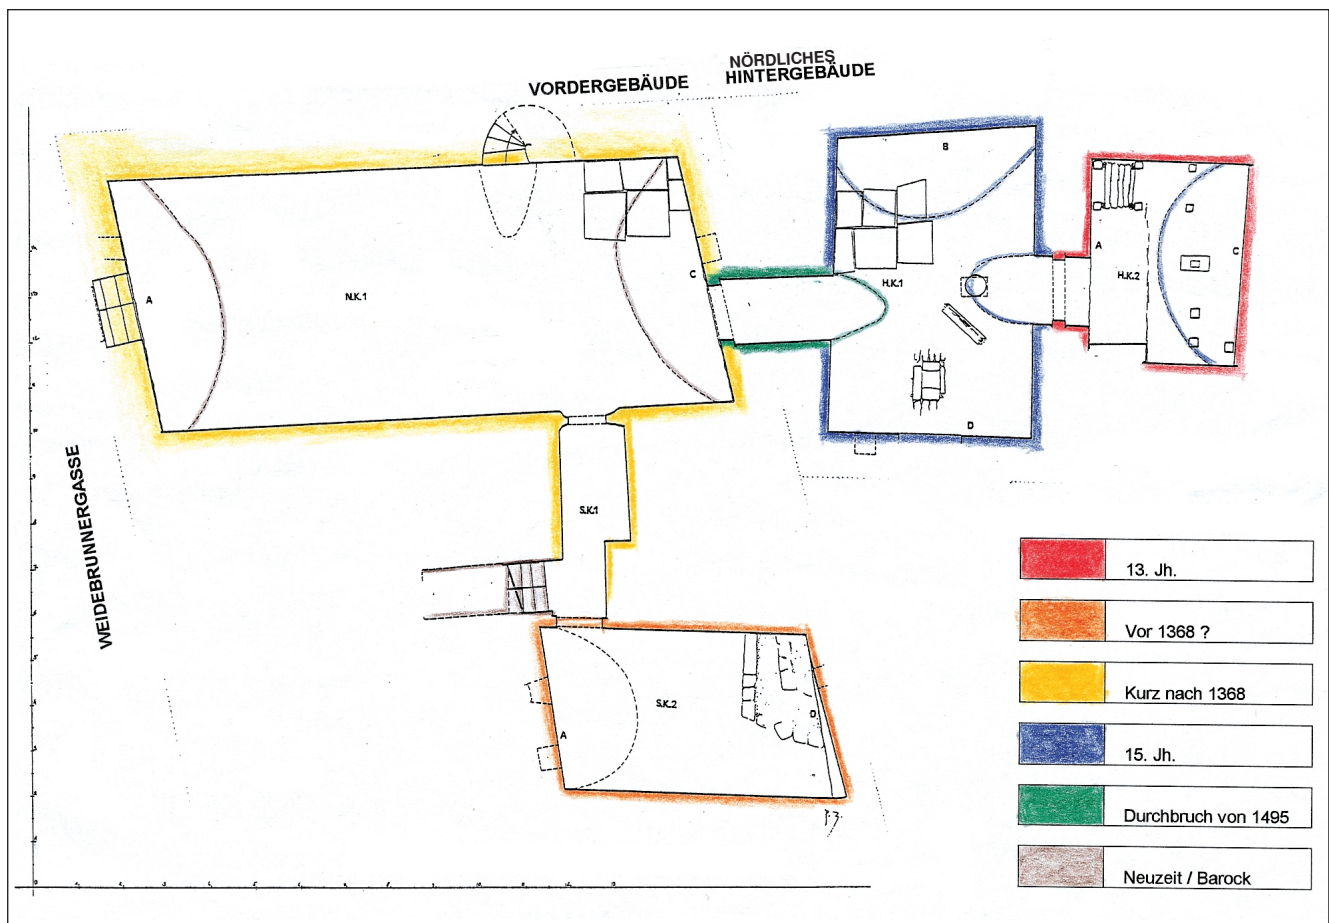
Grundriss des Kellergeschosses unter dem Vorderbau und dem nördlichen Hinterflügel.
